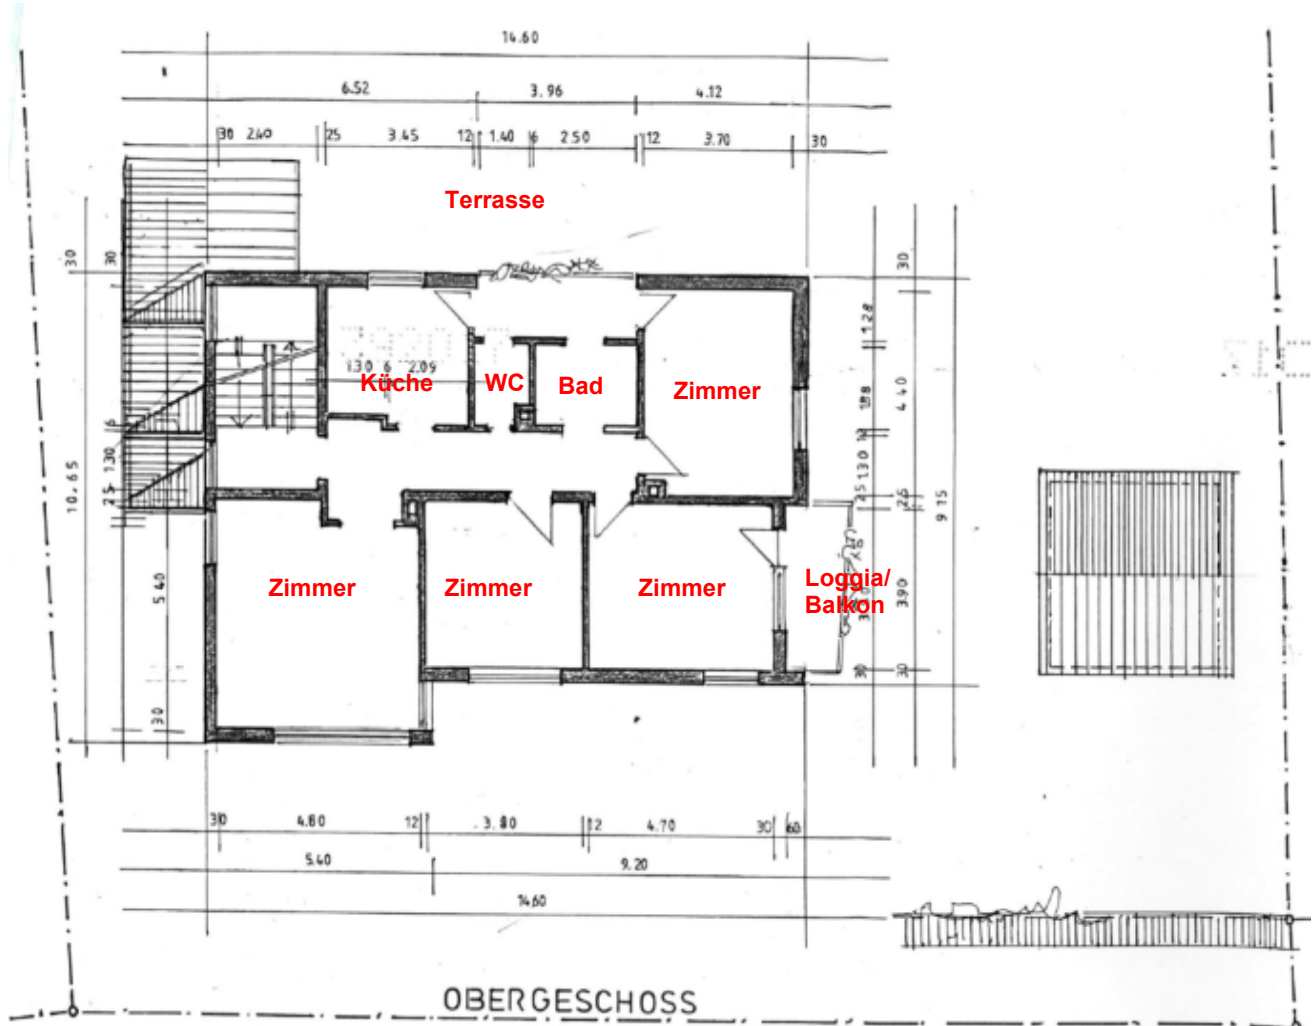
Grundriss Obergeschoss; Quelle: Bauakte; Dachgeschossausbau Nachgesuch; 2017, Roteintragungen durch den SV
